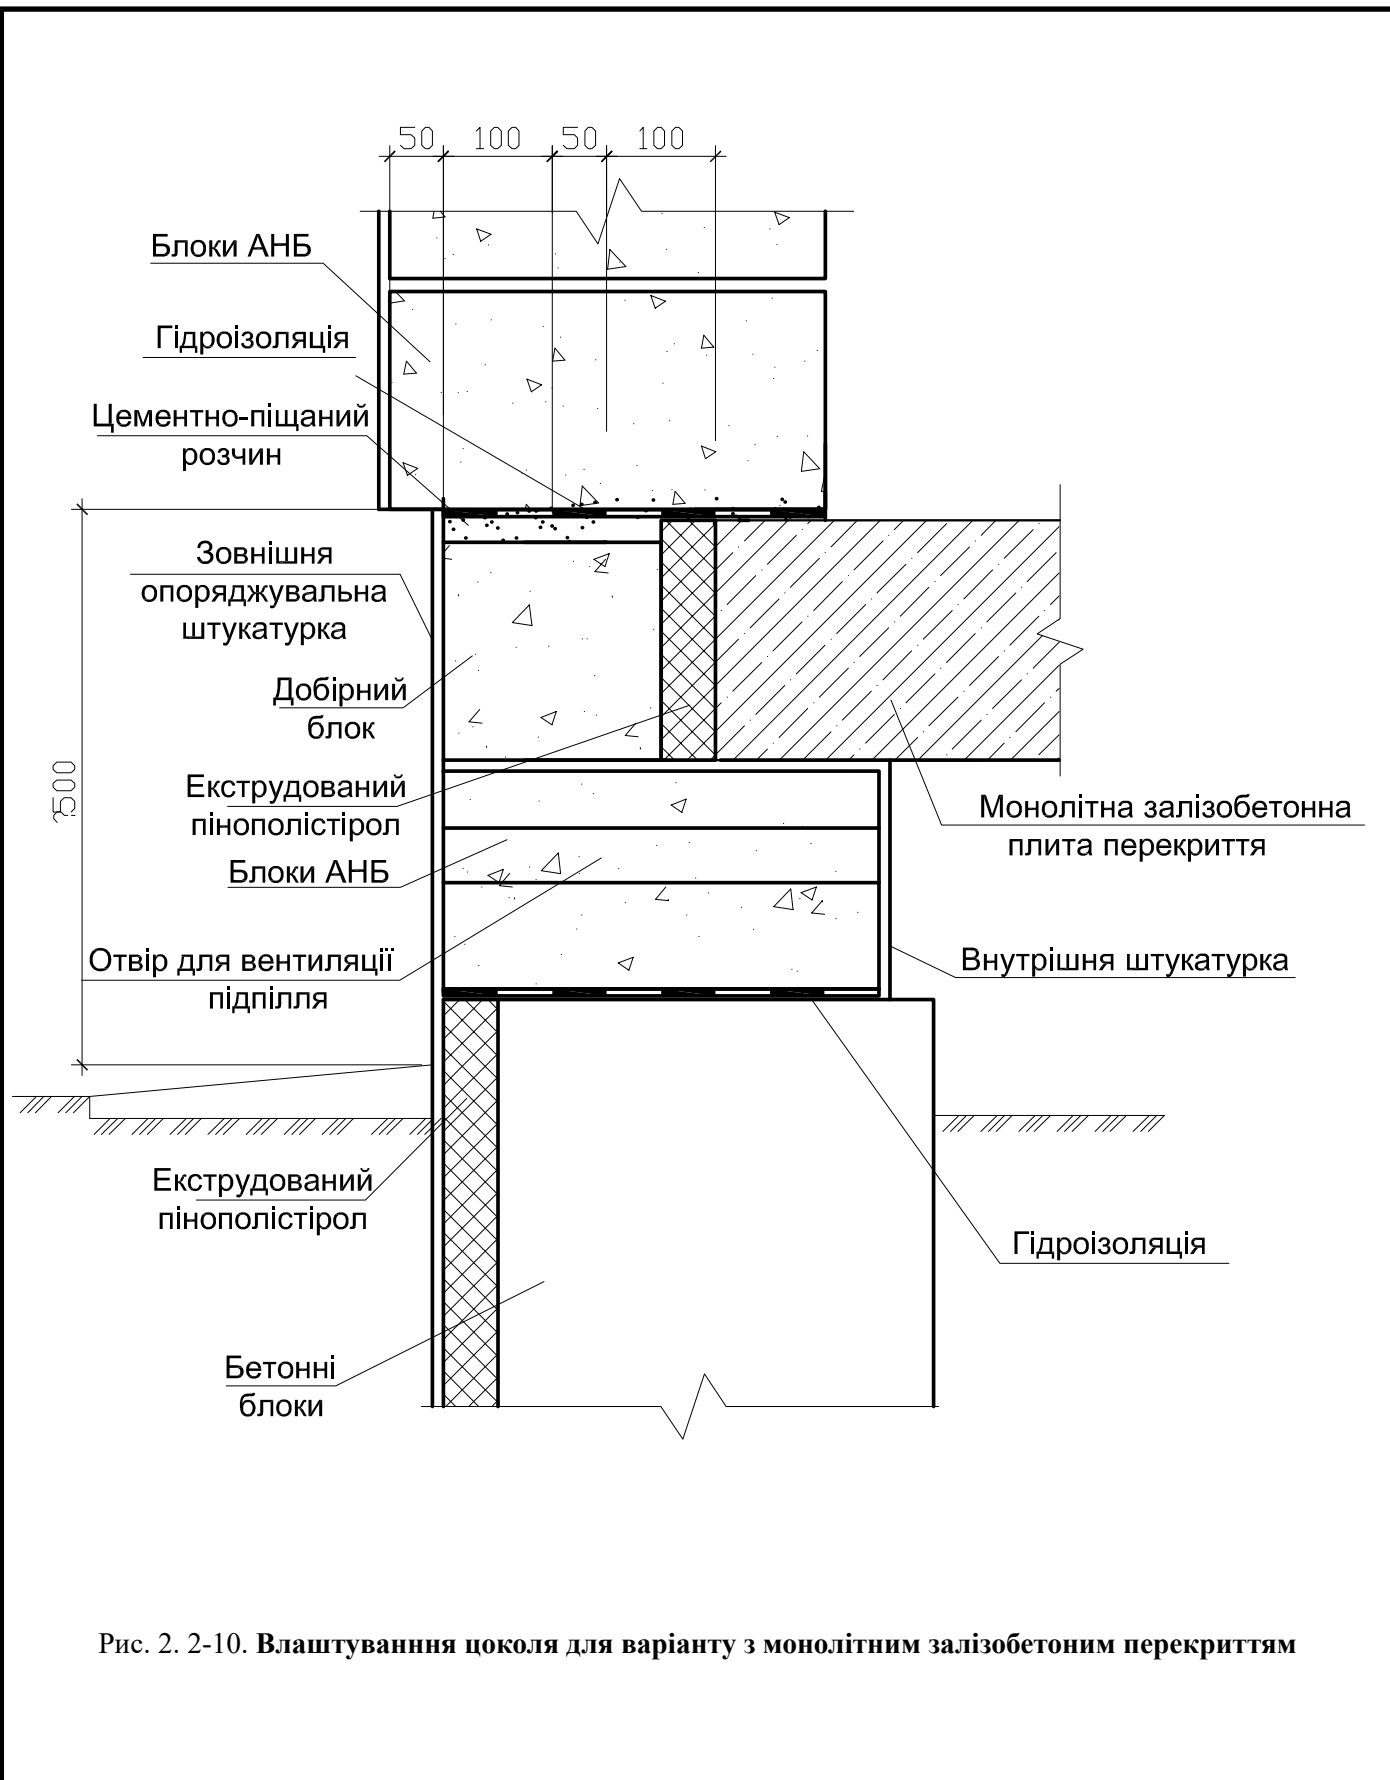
2-10. Влаштування цоколя для варіанту з монолітним залізобетонним перекриттям
